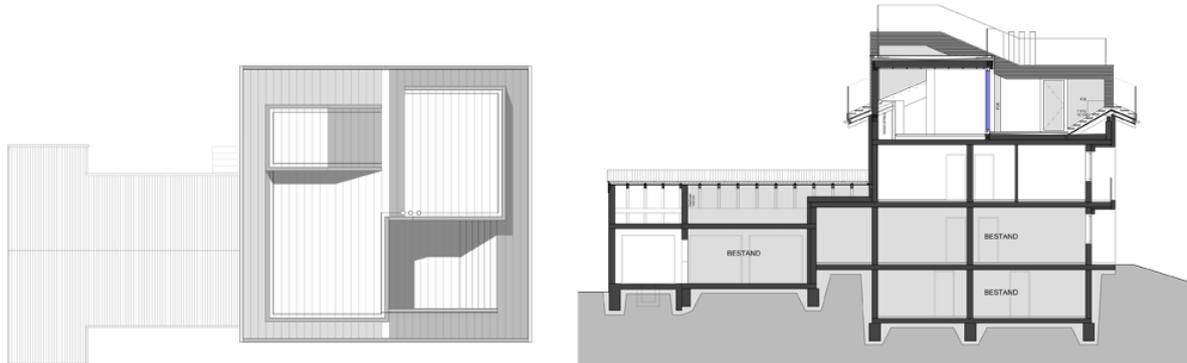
Dachdraufsicht und Schnitt des Hauses
